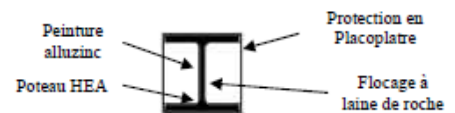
Détail n°02: poteau HEA 300 (1/20)
